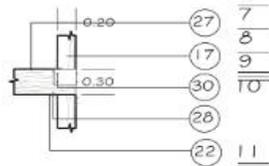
Detalle 6 (Entreteja)-Esc:1/50
